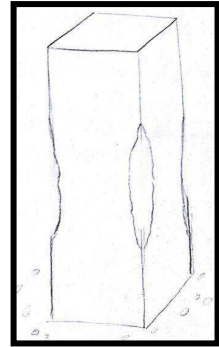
Aplastamiento del hormigón. Fuente: Propia.
